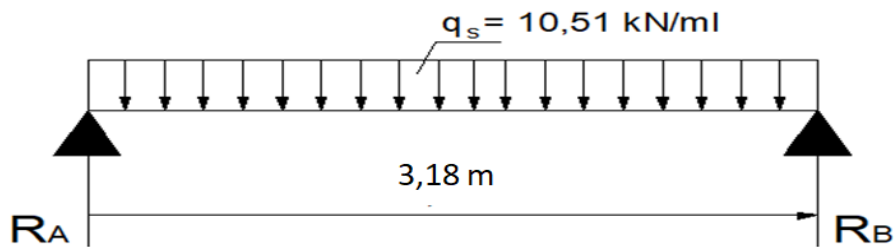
Schéma statique de la poutre chaînée à l'ELS.
